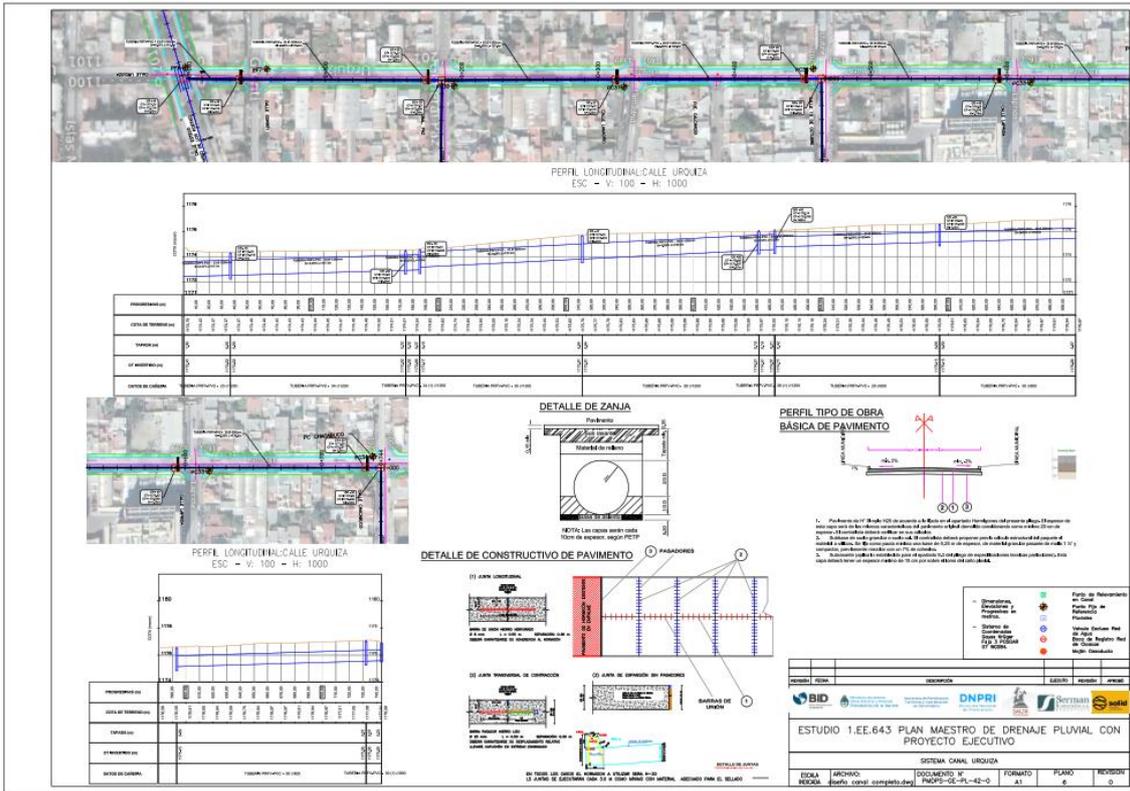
Plan Maestro de drenaje Pluvial – Canal secundario calle Urquiza
